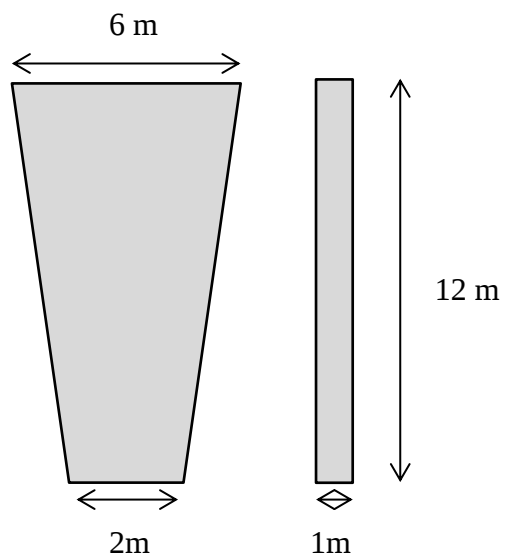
Vista del perfil (izquierda) y frontal (derecha) del PAB
